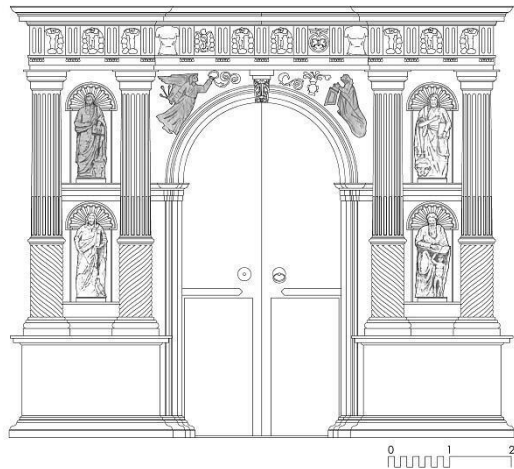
Dibujo del primer piso de la fachada retablo.
